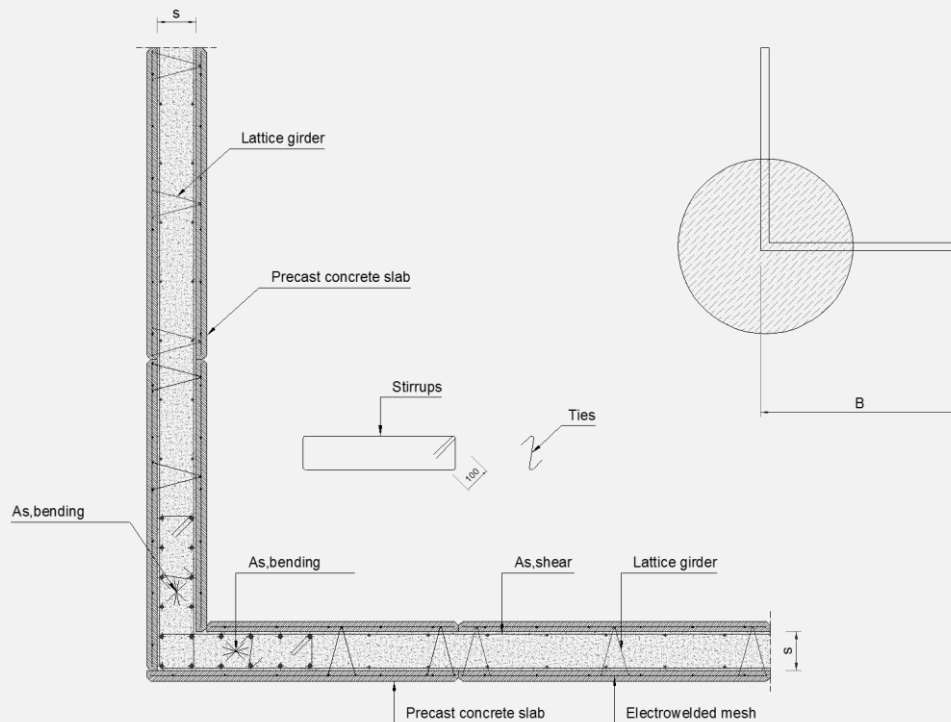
Detaliu structural de colț pentru sistemul de pereți din b.a. pentru contravântuire și dispunere în plan (vedere de sus).
